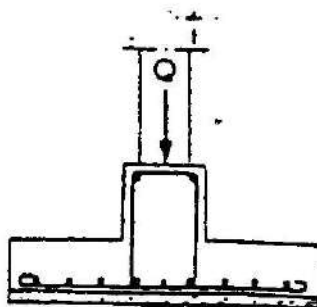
Semelle continue élargie en béton armé « profil en T renversé » avec double réseau d'armatures.
